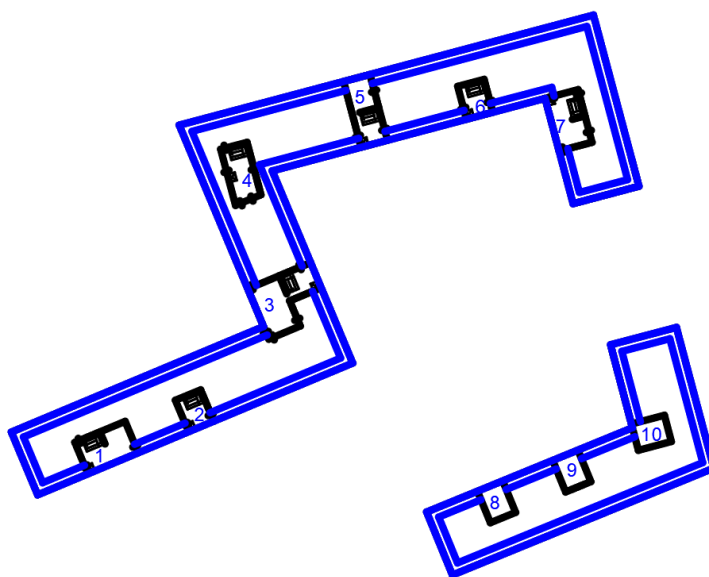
Schema planimetrico coperture con schema di posizionamento perimetrale dell'impianto fotovoltaico
